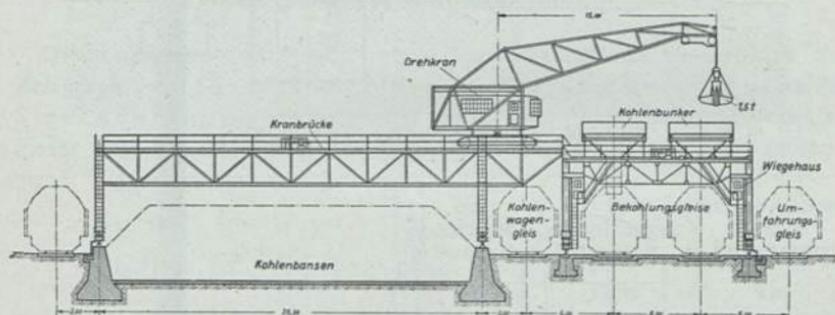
Bekohlungsanlage mit Brückenkran und Kohlenbunker
